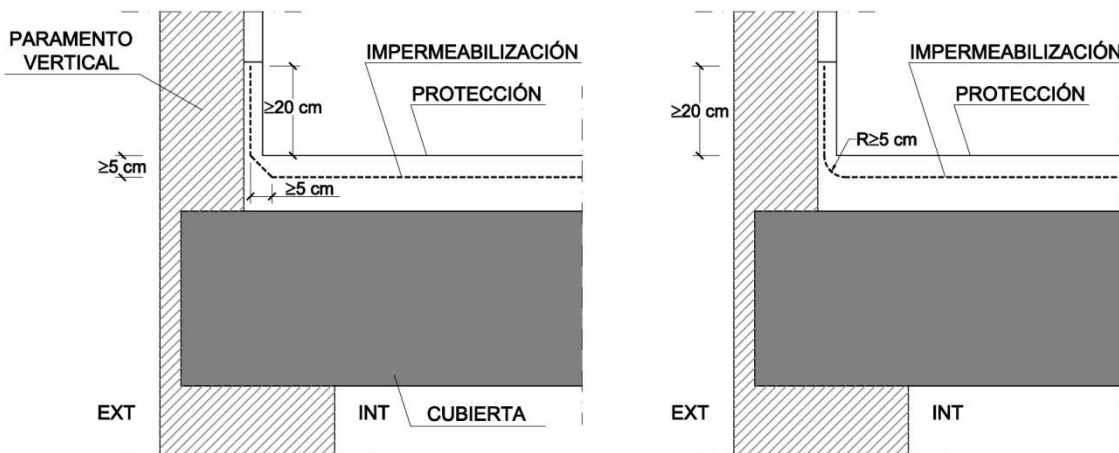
Encuentro de la cubierta con un paramento vertical
